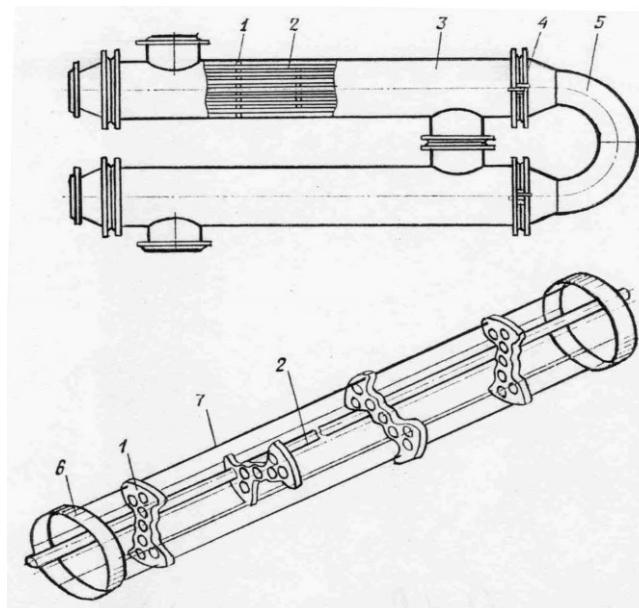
Секційний кожухотрубчастий водопідігрівник: 1 - опорна перегородка; 2 - трубка; 3 - корпус; 4 - шарнір; 5 - з'єднувальний калач; 6 – кільце
